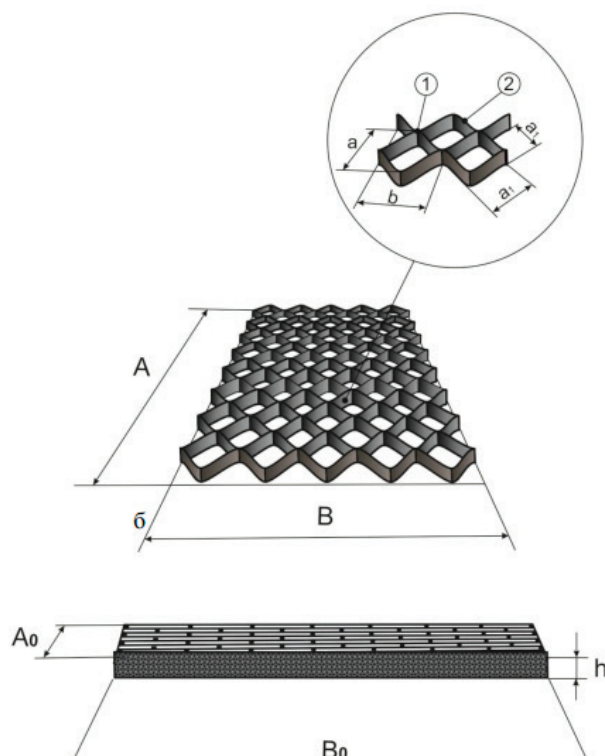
Общая схема георешеток в рабочем состоянии: 1 — сварной шов, 2 — геополосы, A и B — длина и ширина модуля, a и b — размер ячейки по диагонали в направлении длины и ширины
